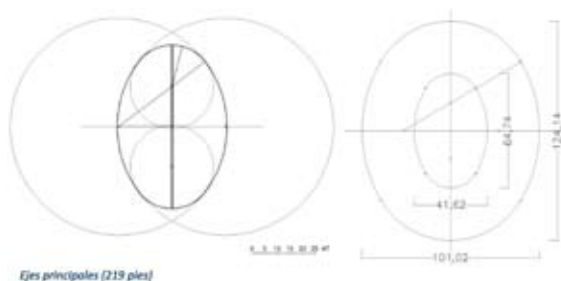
Planta del anfiteatro donde se analiza su módulo constructivo.
